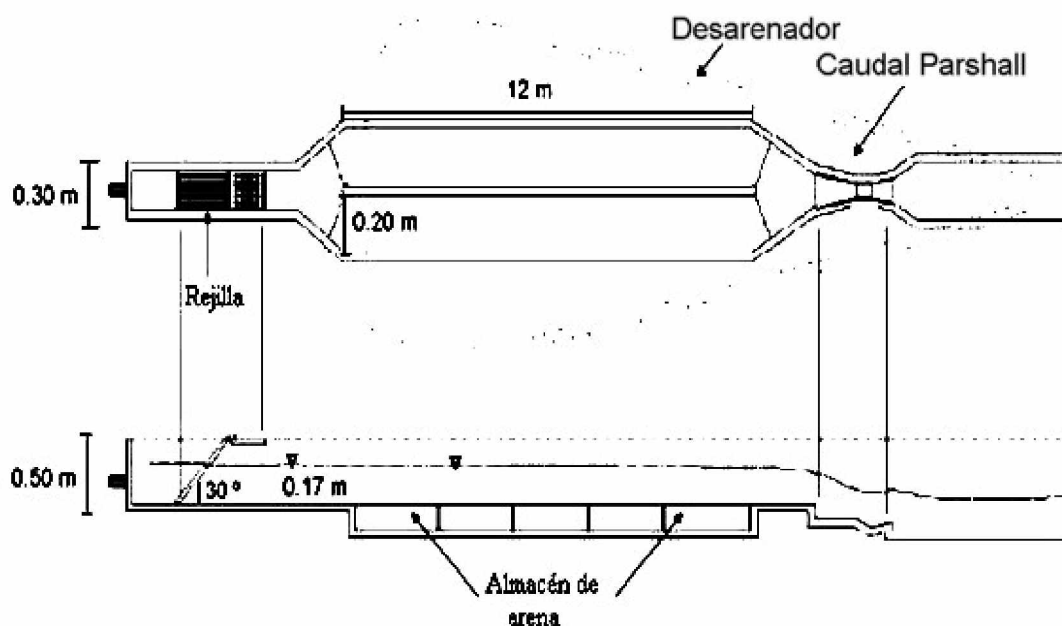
Esquemas de rejillas y desarenador para la Planta N°3
